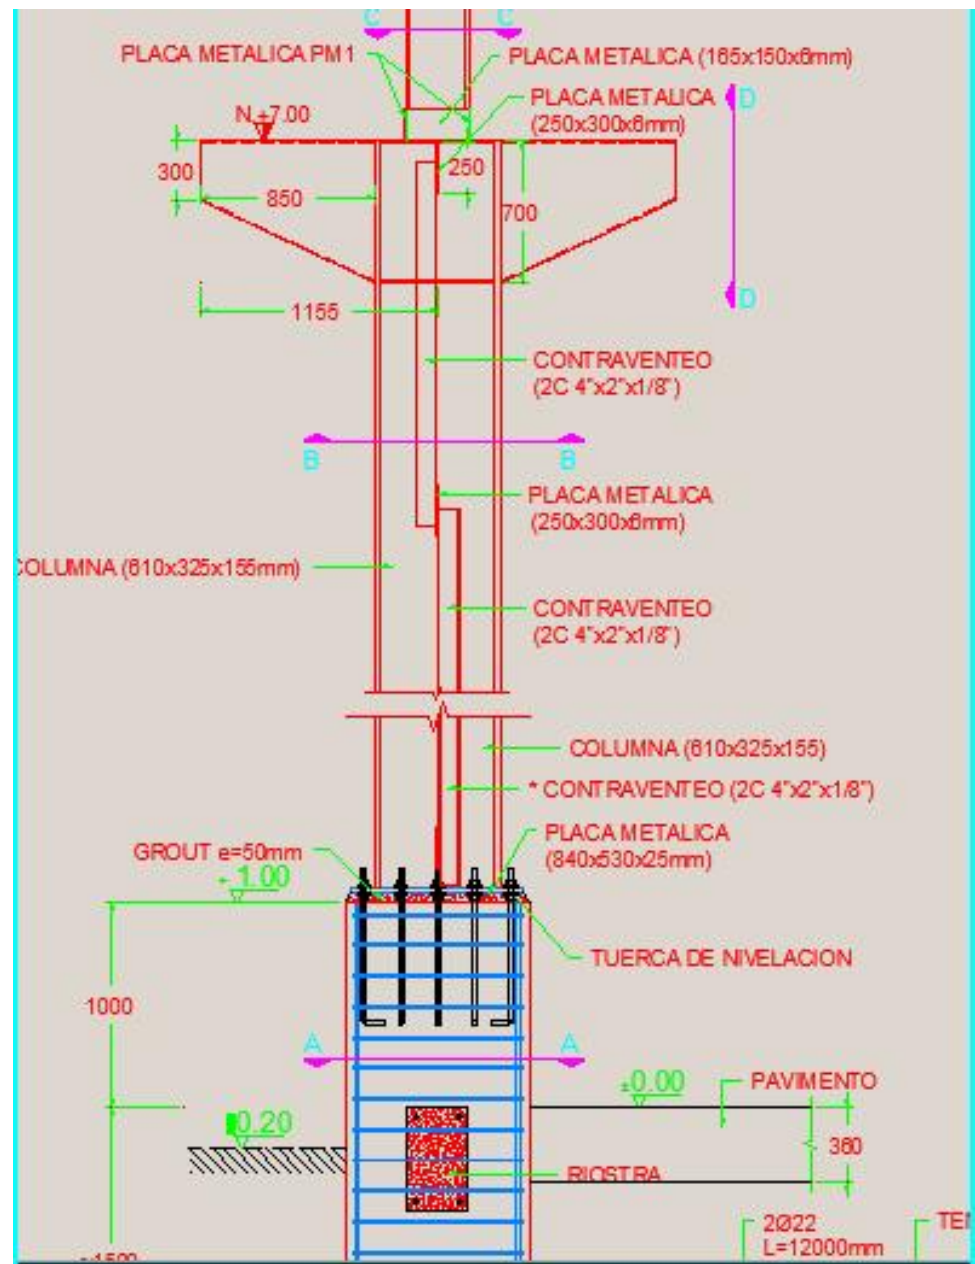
DETALLE DE PILAR CON LA MÉNSULA
